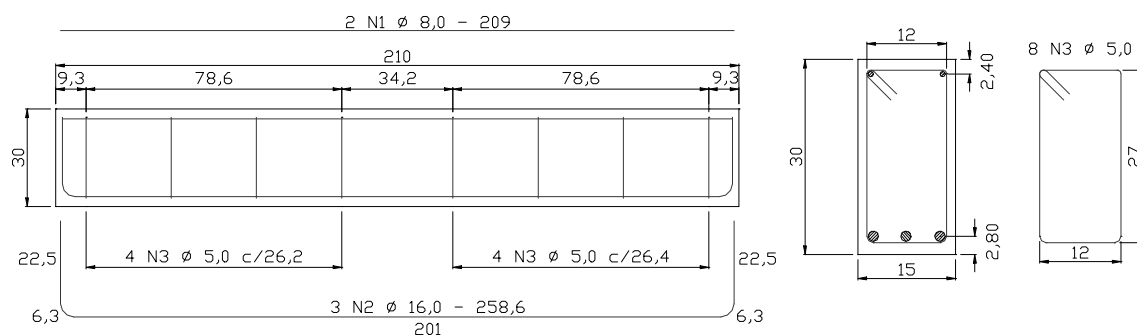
Detalhamento das armaduras das vigas com estribos convencionais (cotas em cm)
